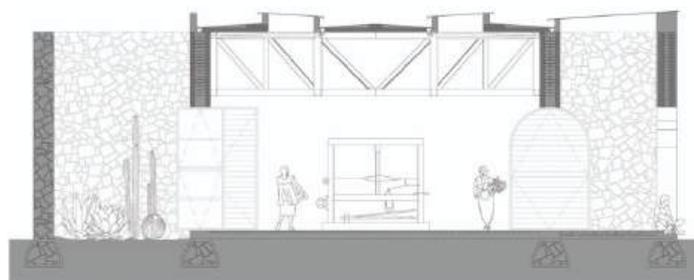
Mercado Tlaxco. Sección. (Archdaily.2020)
